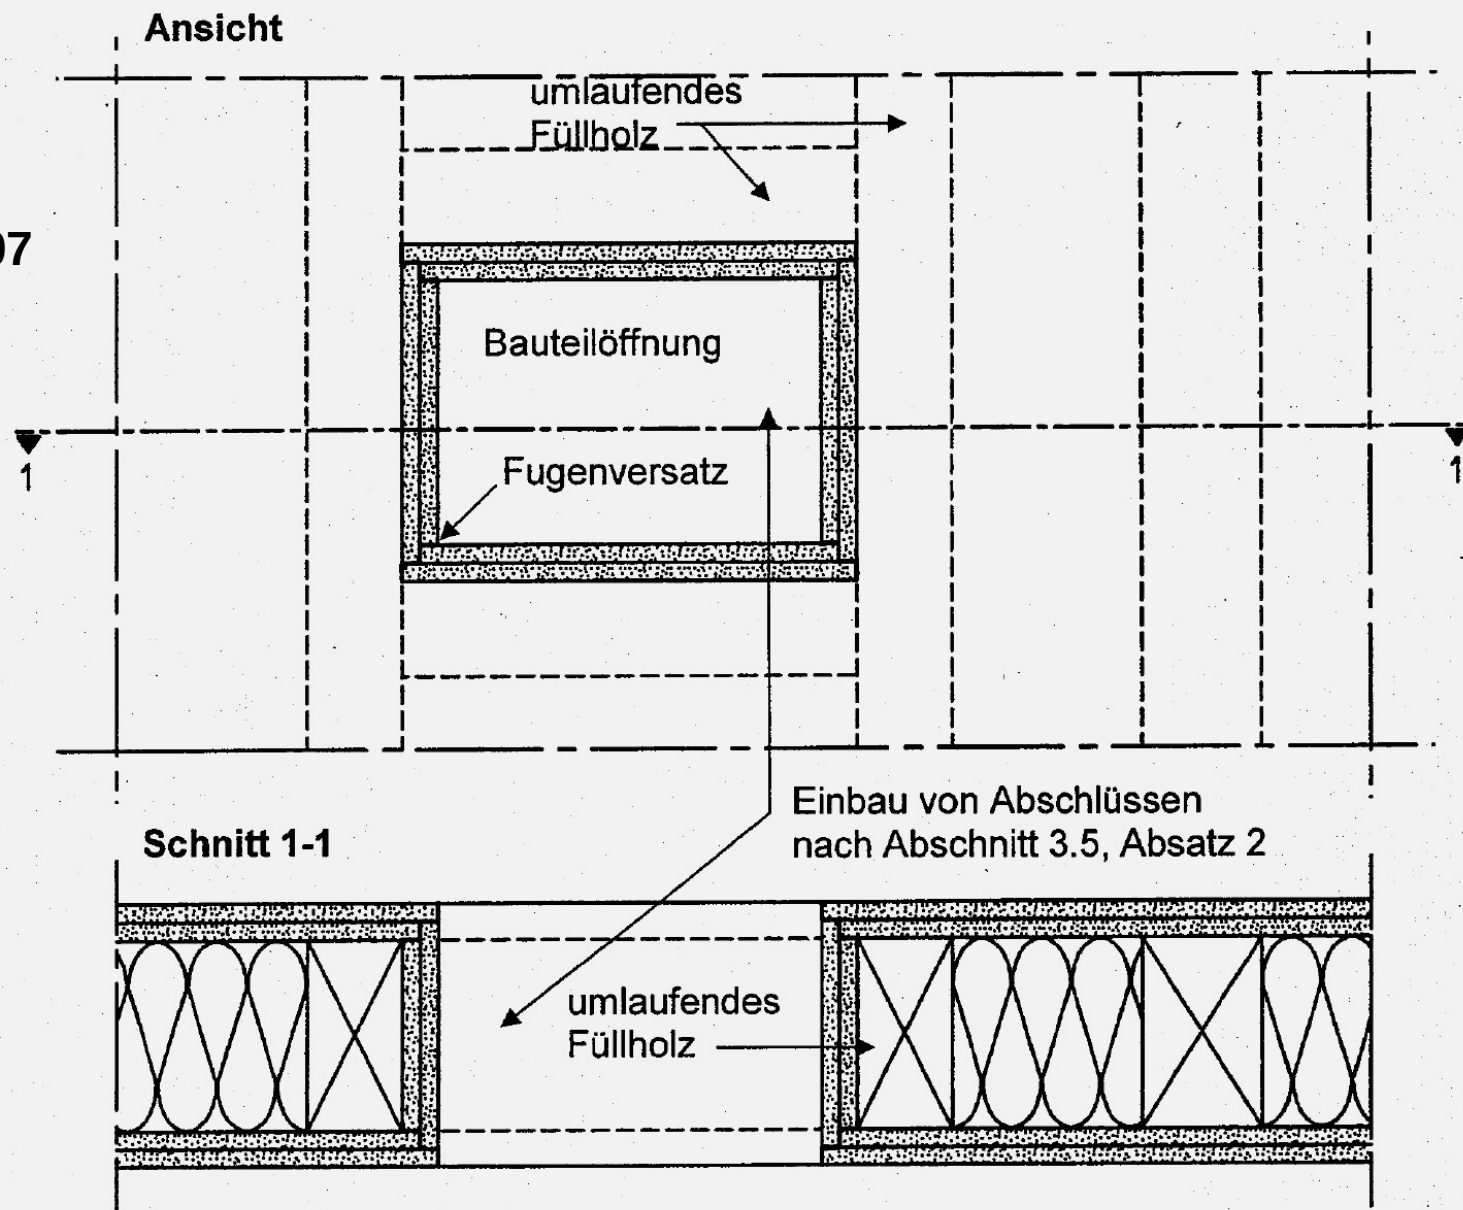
Bauteilöffnung mit Brandschutzbekleidung nach Abschnitt 3.2 zum Einbau von Türen, Fenstern und sonstigen Einbauten nach Abschnitt 3.5
